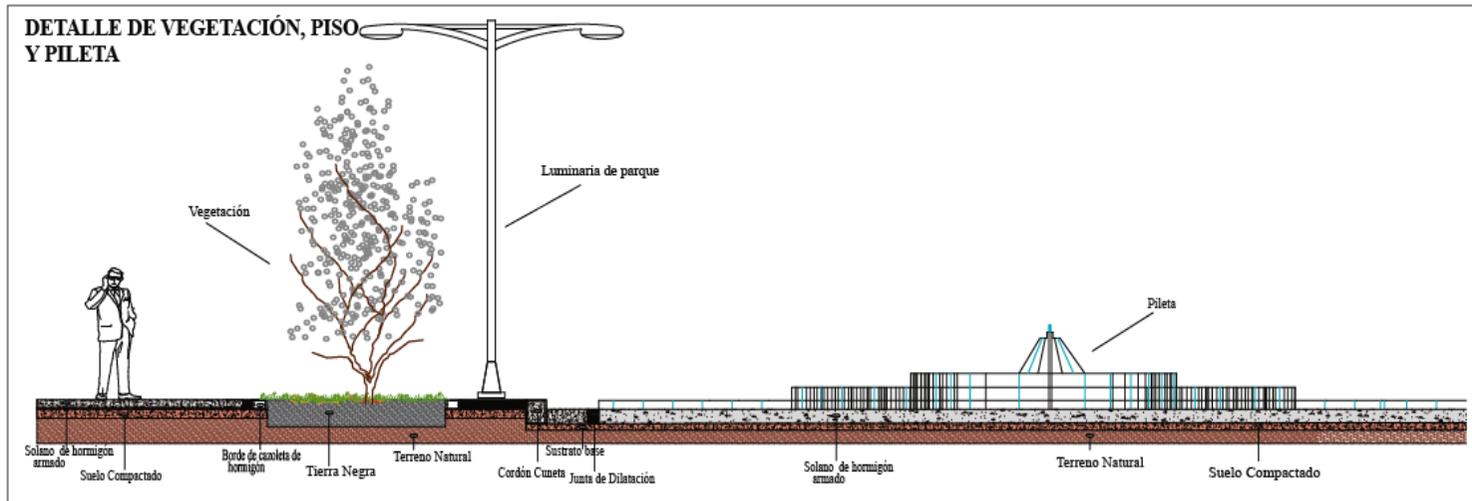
Propuesta detalles constructivos parques, Sector Ingahurco
